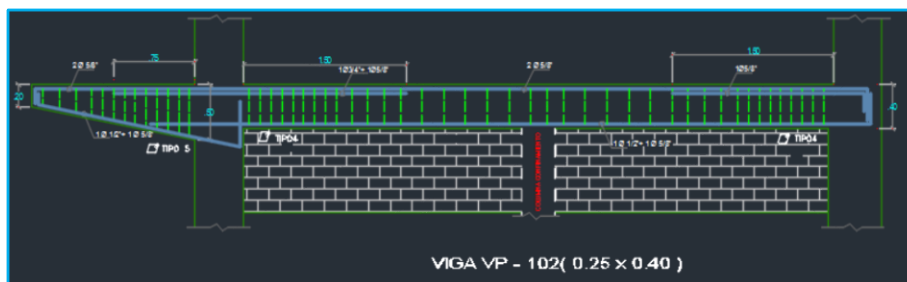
Detalle de las dimensiones de la viga VP-102 y el acero de refuerzo
